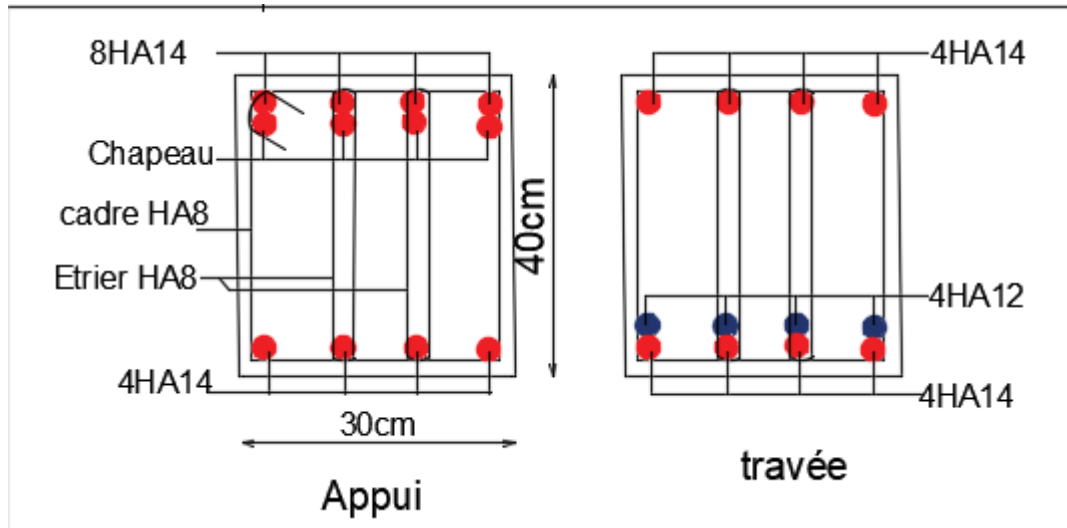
Schéma de ferrailage de la poutre principale sous-sol
